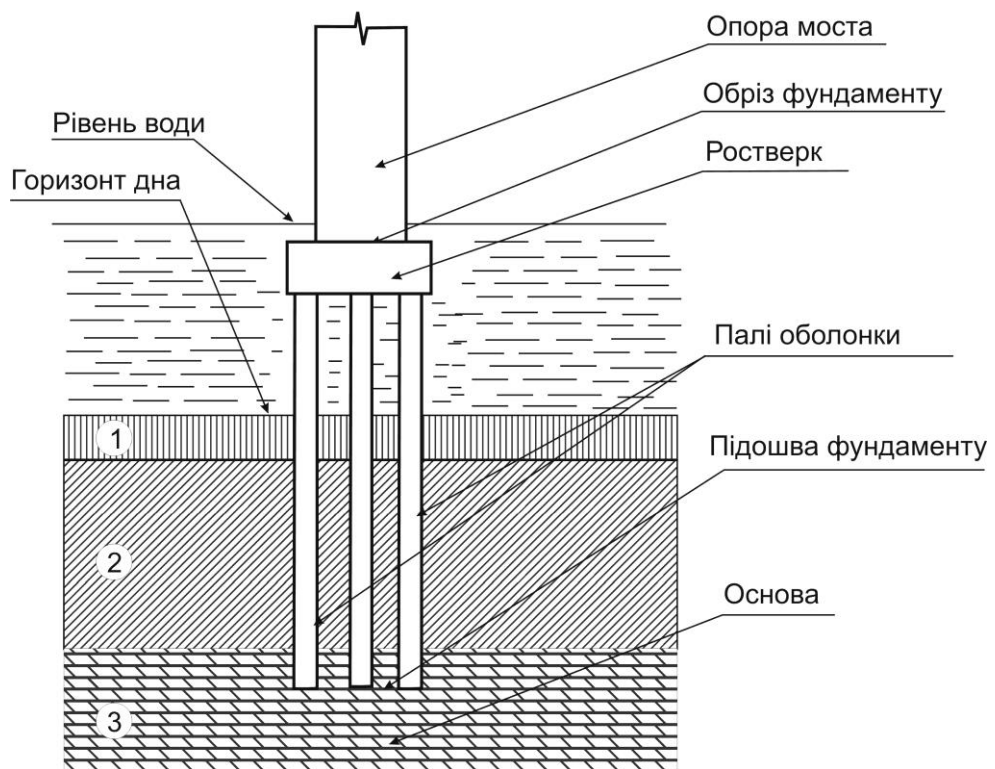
Пальовий фундамент із паль-оболонки з високим ростверком на водотоці
